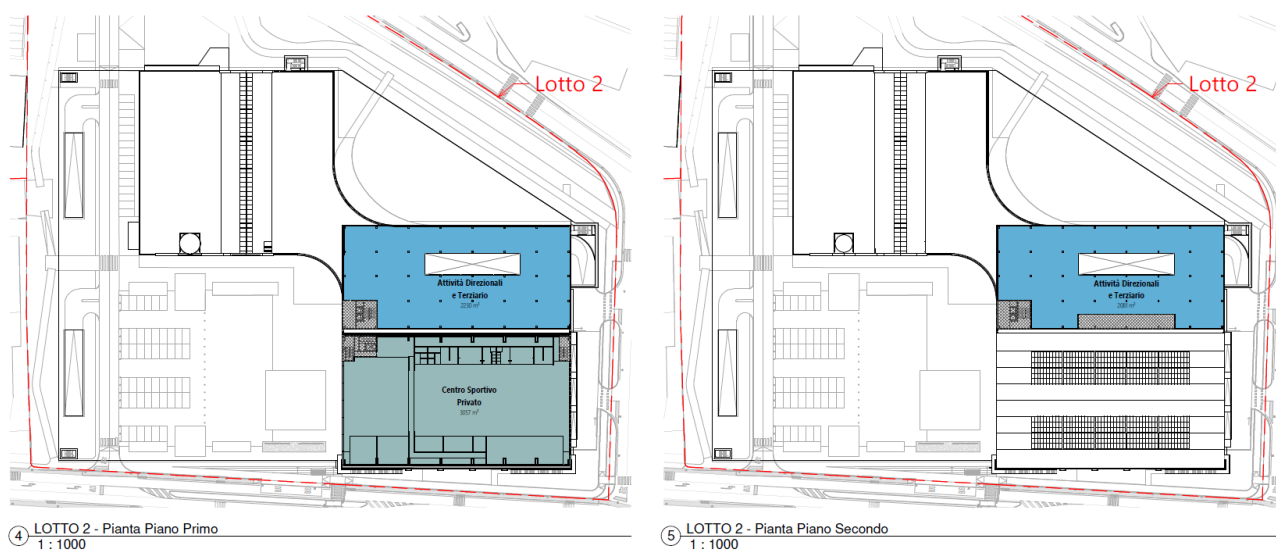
Stralci piante del Complesso Multifunzionale - Piano primo e piano secondo.
